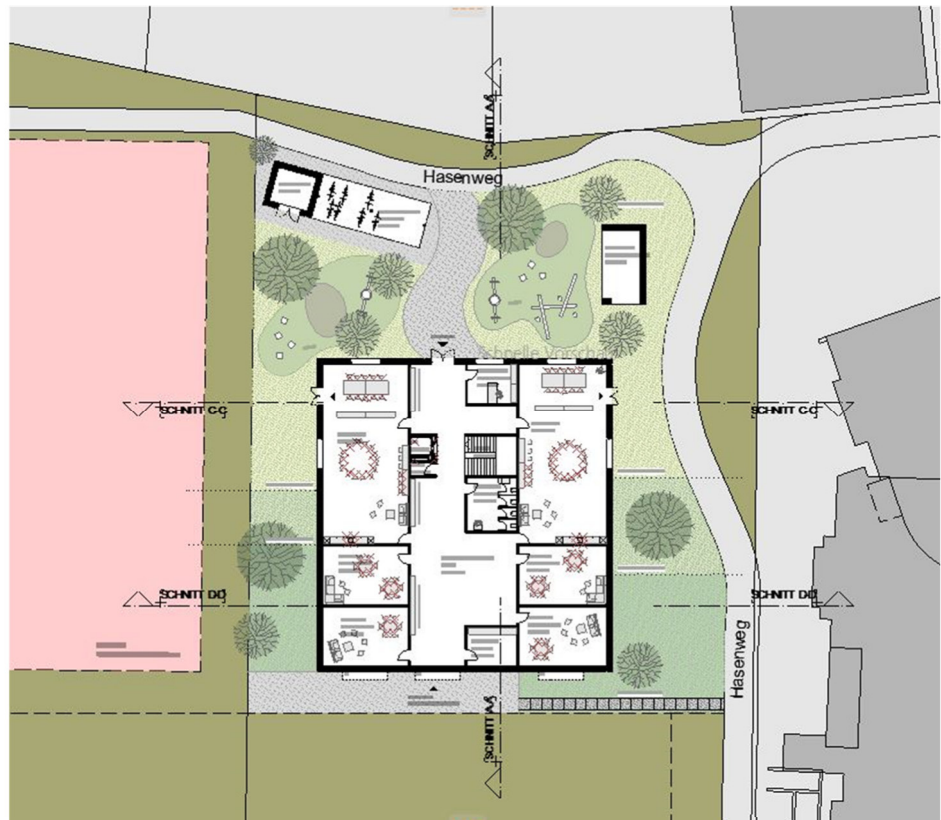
Disposition 01 | Grundriss Erdgeschoss
